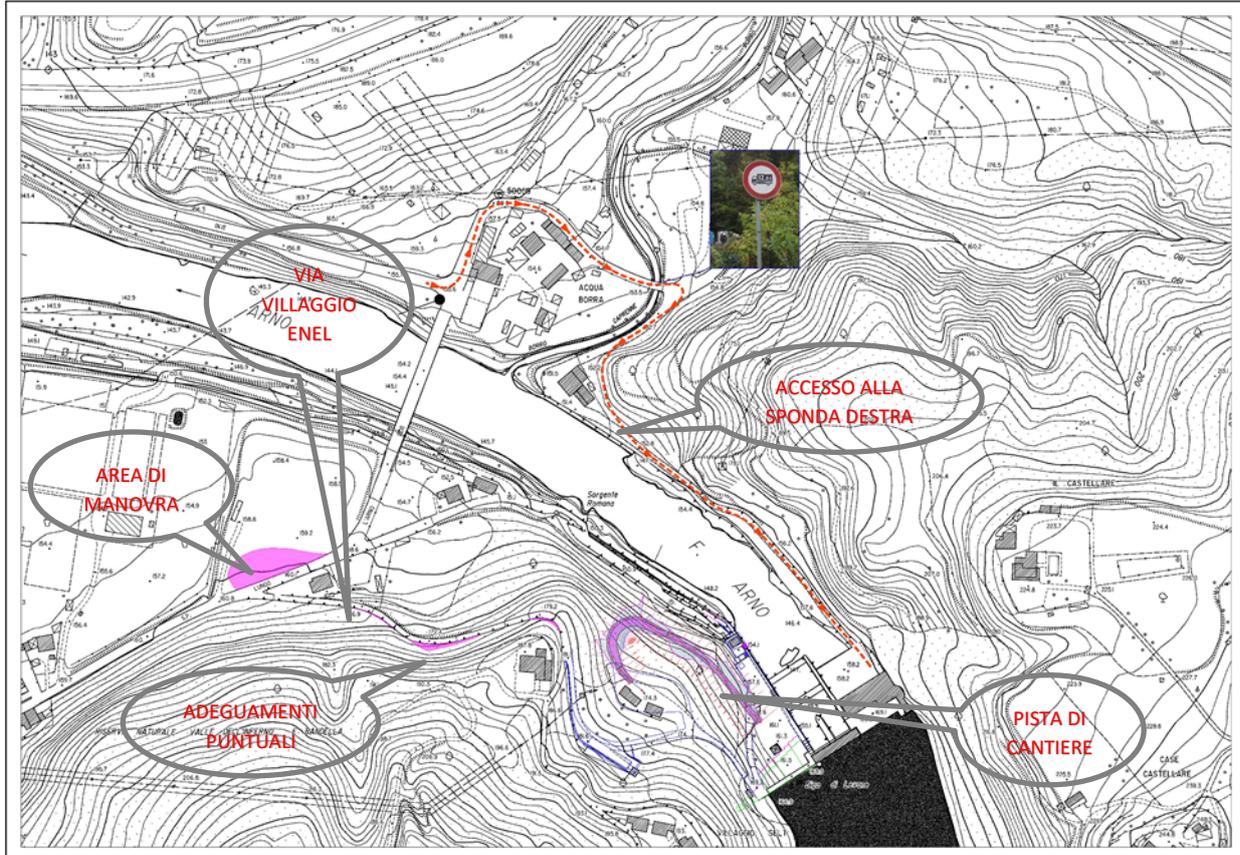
stralcio planimetrico accessibilità alle aree di cantiere
